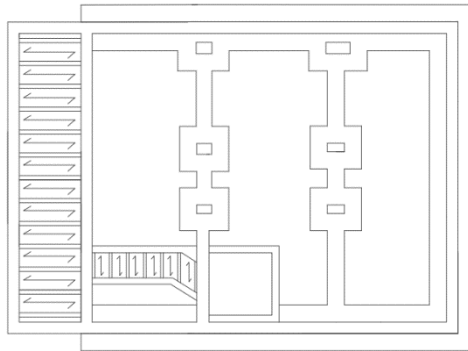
Plano de cimentaciones y estructura de planta baja. Fuente: CAD propio
